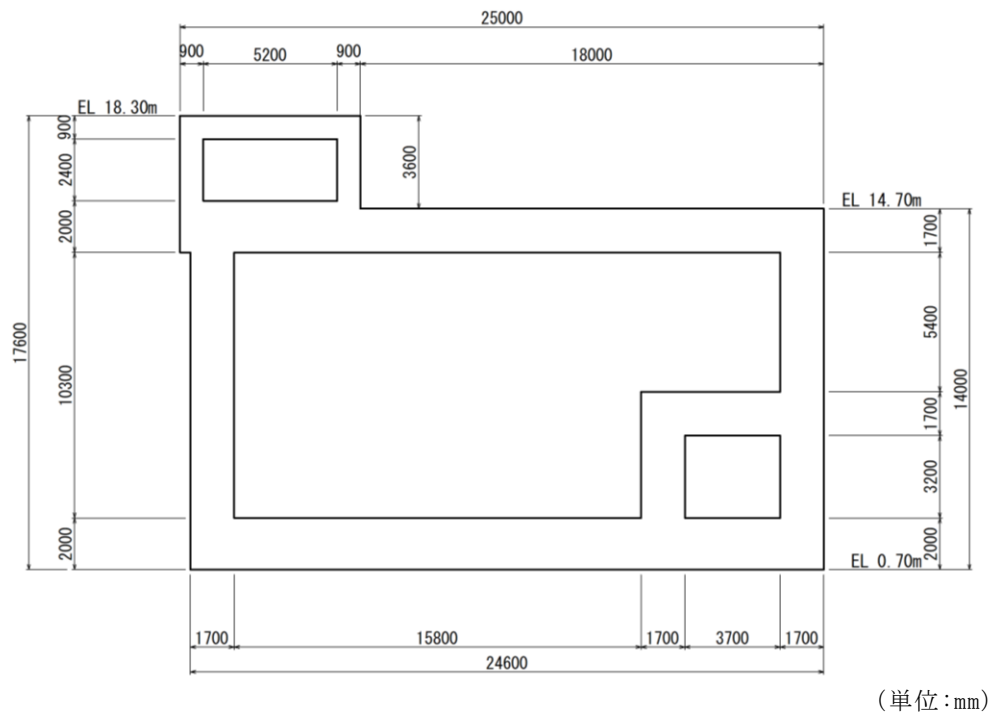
第 1 ベントフィルタ格納槽 断面図 (C-C 断面)
